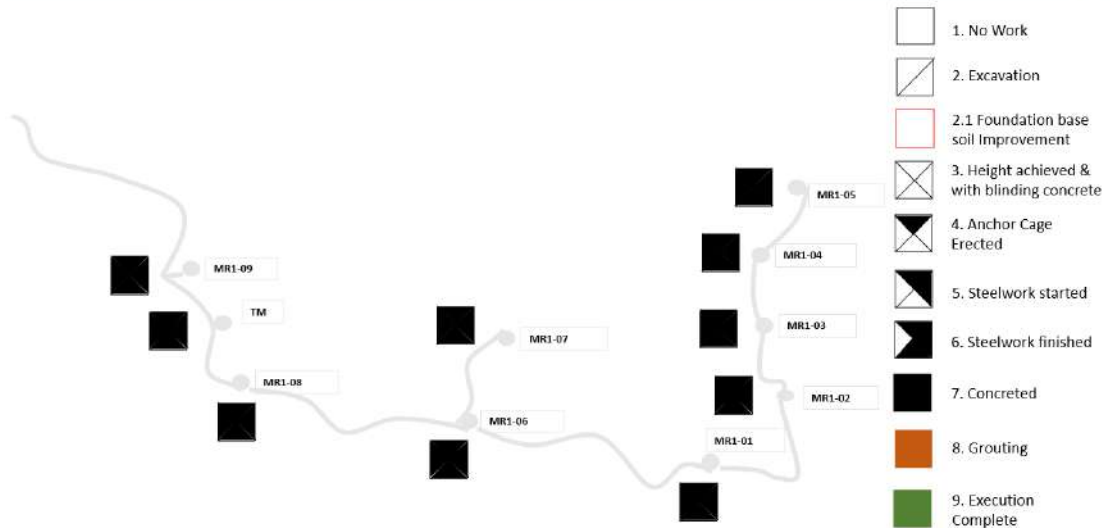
Estado y plano de obras ejecutadas a fin de mes.
